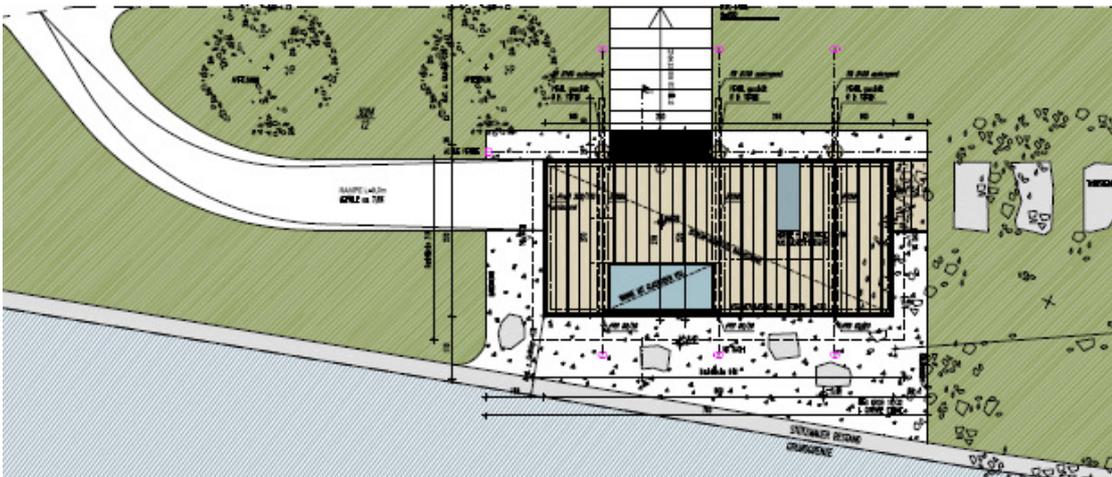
Grundriss Pavillon Seewalchen
